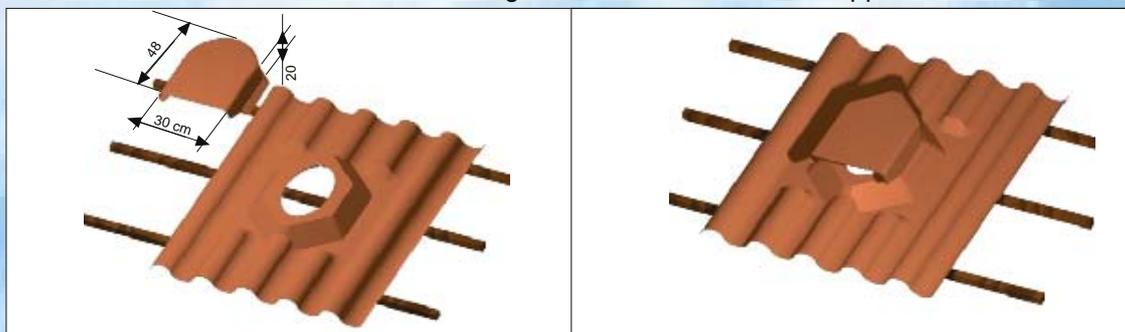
Cuffia per areatore. Apertura frontale 16x27 cm. Dimensioni di ingombro del pezzo installato 48x30x20 cm.
